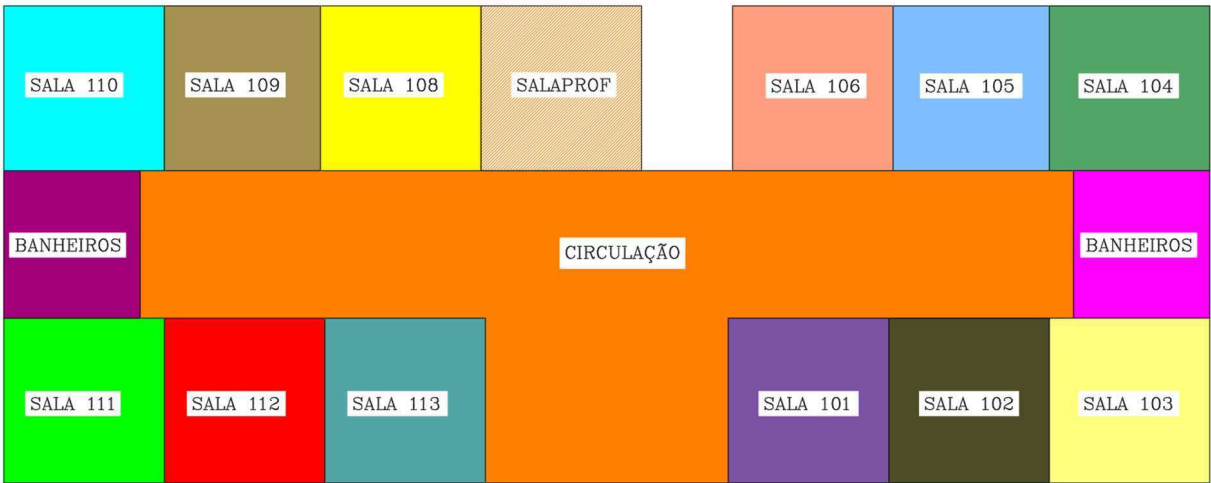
Planta baixa com as Zonas Térmicas do 2º Pavimento.
